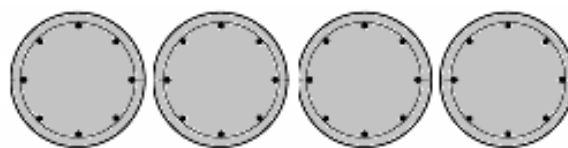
Disposition des pieux dans un mur en pieux jointifs
